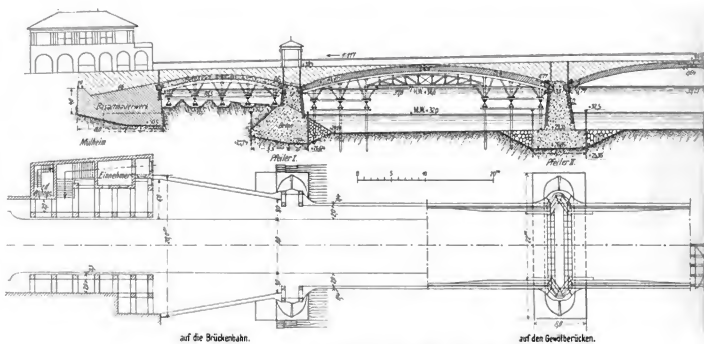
und 5. Längsschnitte und Grundrisse.
